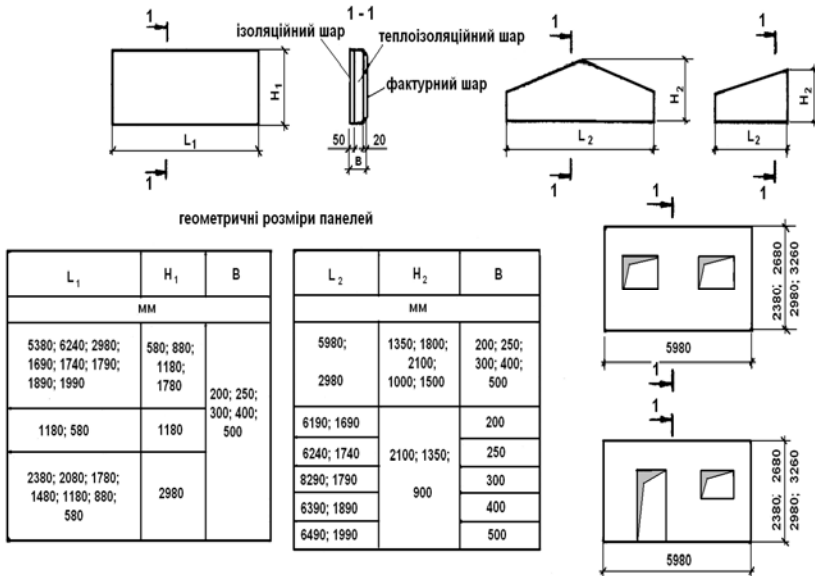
Стінові двошарові панелі з легких бетонів
